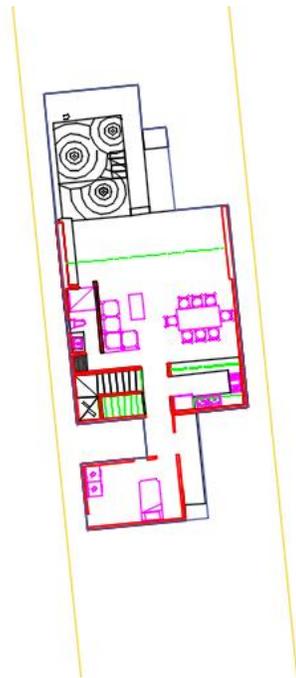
En la imagen se muestran las áreas que comprenderán la planta baja.
